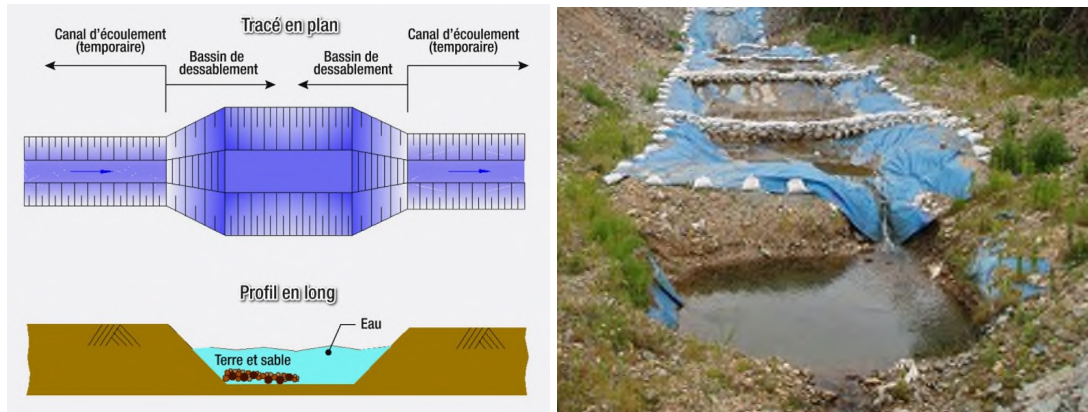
Exemple du plan d'installation de la retenue d'eau et du bassin de dessablement (permanents)
